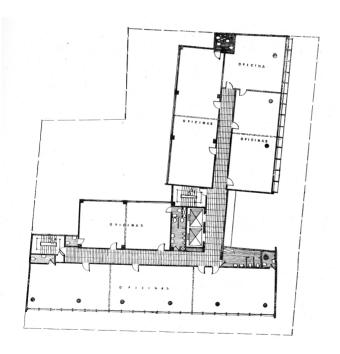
Edificio Atlas - Planta Sótano - Novena planta alta Fuente: http://laformamodernaenlatinoamerica.blogspot.pe/2014/02/ Digitalización: Davila, A. (2016)
